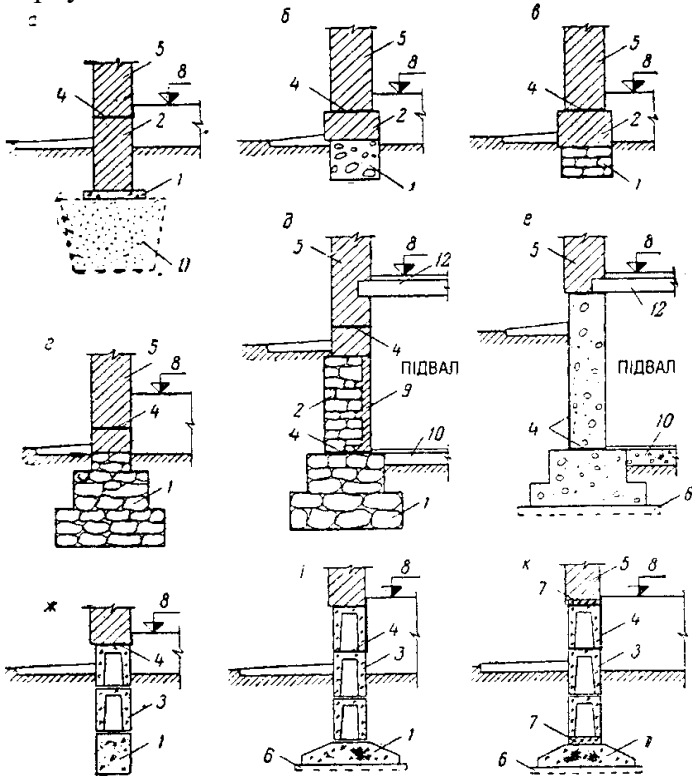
Стрічкові фундаменти: а - піщана подушка; б - бутобетонний; в - бутовий; г - бутовий з уступами; д - бутовий у будинку з підвалом; е - бутобетонний з підвалом; ж, і, к - збірні: 1 - монолітний або збірний фундамент; 2 - фундаментна стіна; 3 - фундаментний стіновий блок; 4 - гідроізоляція; 5 - стіна підземної частини будинку; 6 - шар піску або щебеню товщиною 50-100 мм; 7 - арматурний пояс; 8 - рівень підлоги першого поверху; 9 - цегляне облицювання; 10 - підлога підвалу; 11 - піщана подушка; 12 - надпідвальне перекриття.
